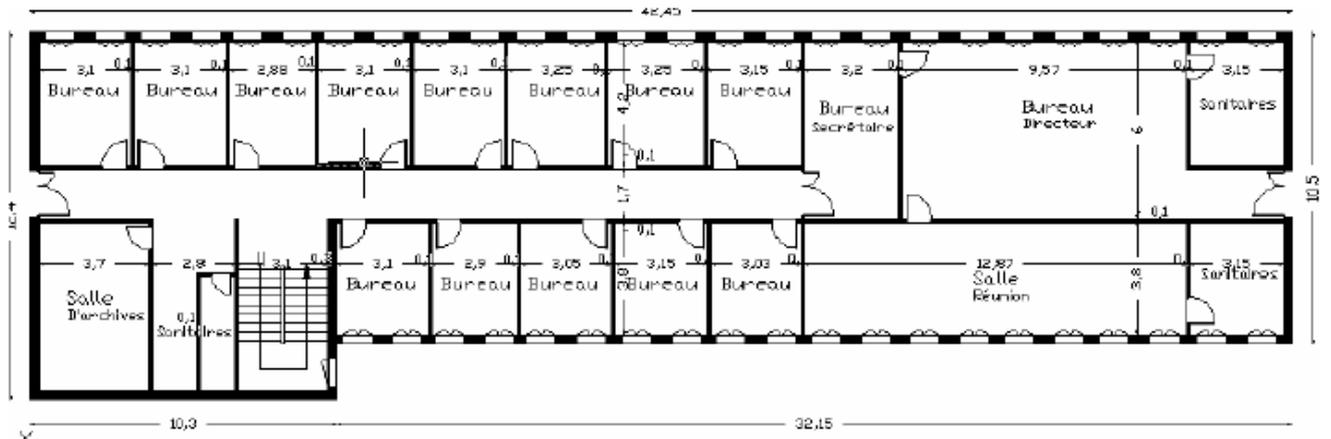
Plan du rez-de-chaussée, source : DUAC de Tizi Ouzou
